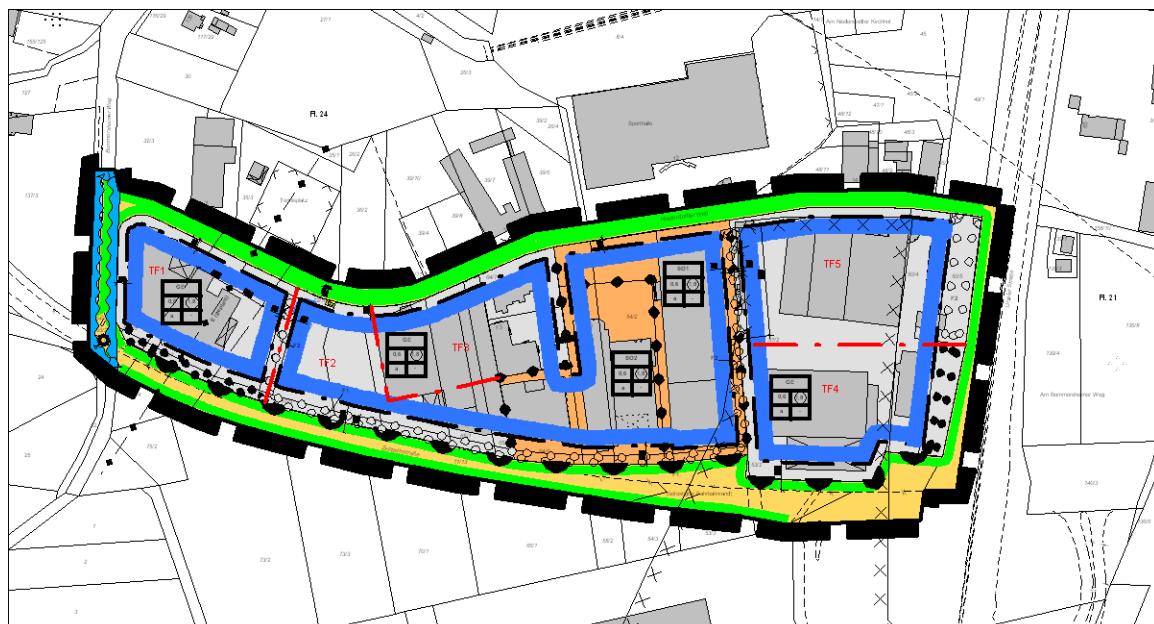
Geltungsbereich und Abbildung des Bebauungsplans
